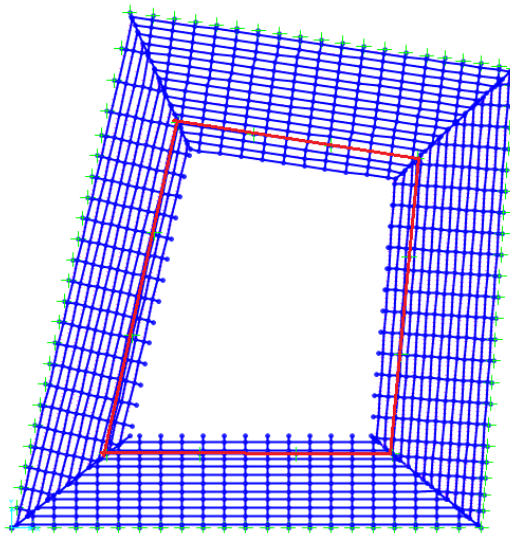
Vigas ortogonales - SAP2000. Fuente: Autores
